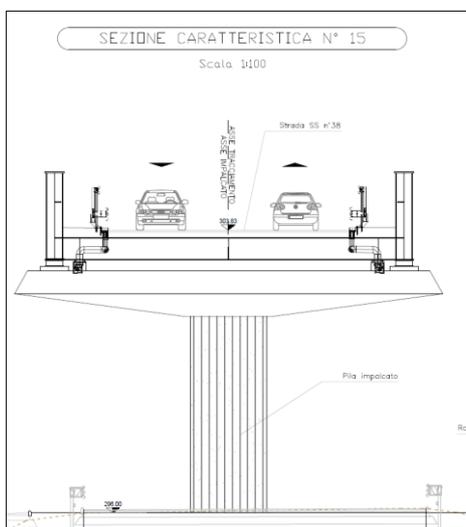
Stralcio elaborato n. 306 (PFTE)
